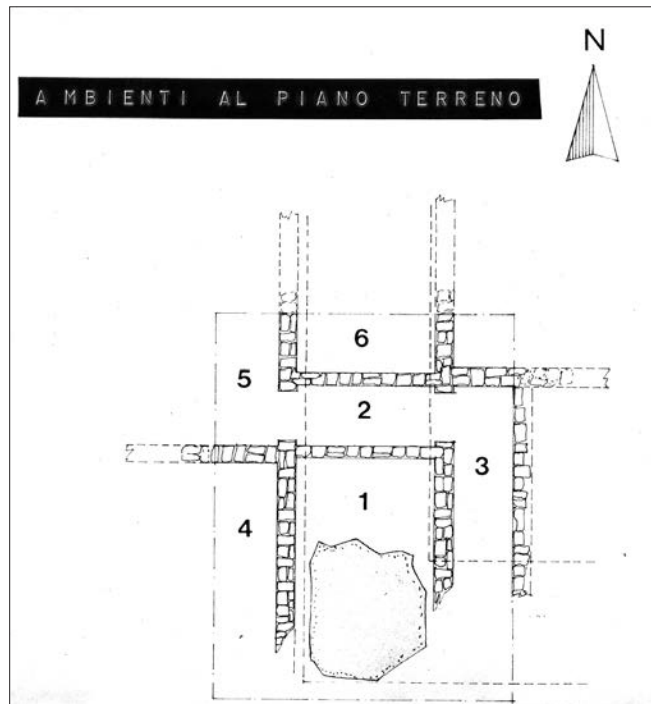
Planimetria dello scavo 1969 (dall'album fotografico a corredo della relazione 1969, Archivio F. Mastrodicasa Rinaldi e Fondo M. Santangelo).
